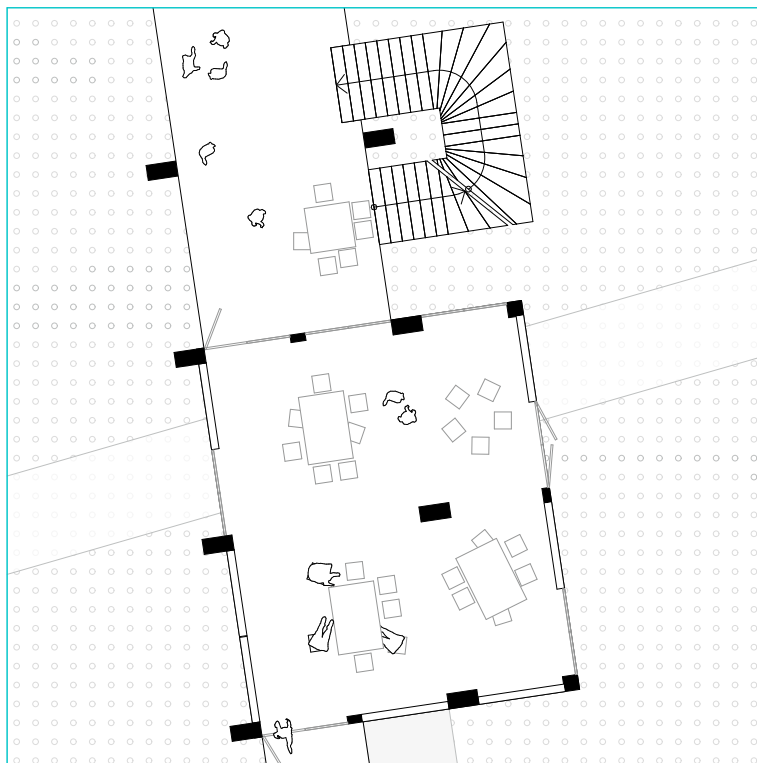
Ausschnitt Grundriss 1. Ebene 1:200
